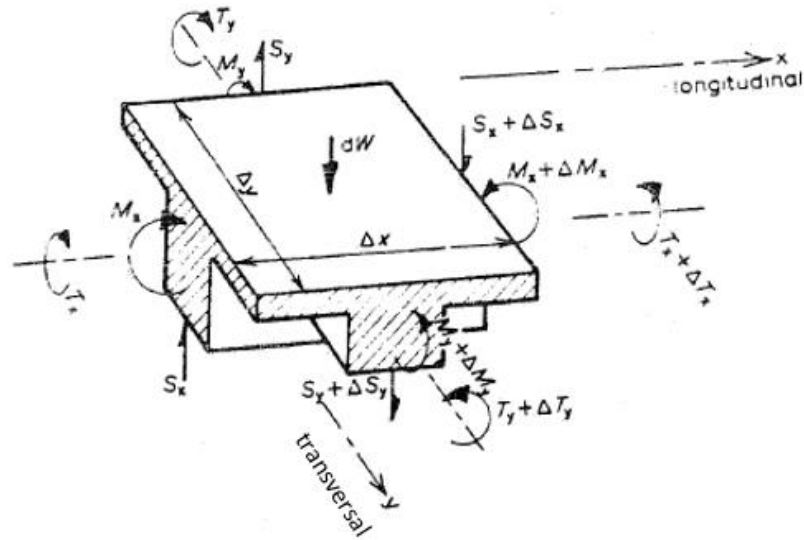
Elemento de tabuleiro em grelha ou tabuleiro em vigas e laje com transversina. Fonte: Adaptado de Hambly (1991)
